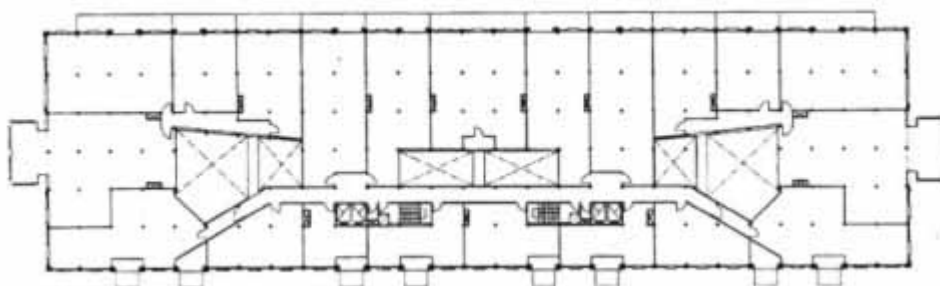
planta 2º e 3º pavimento do Galpão 5, onde se distribuem as unidades habitacionais. Fonte: Revista Arquis nº 1.
